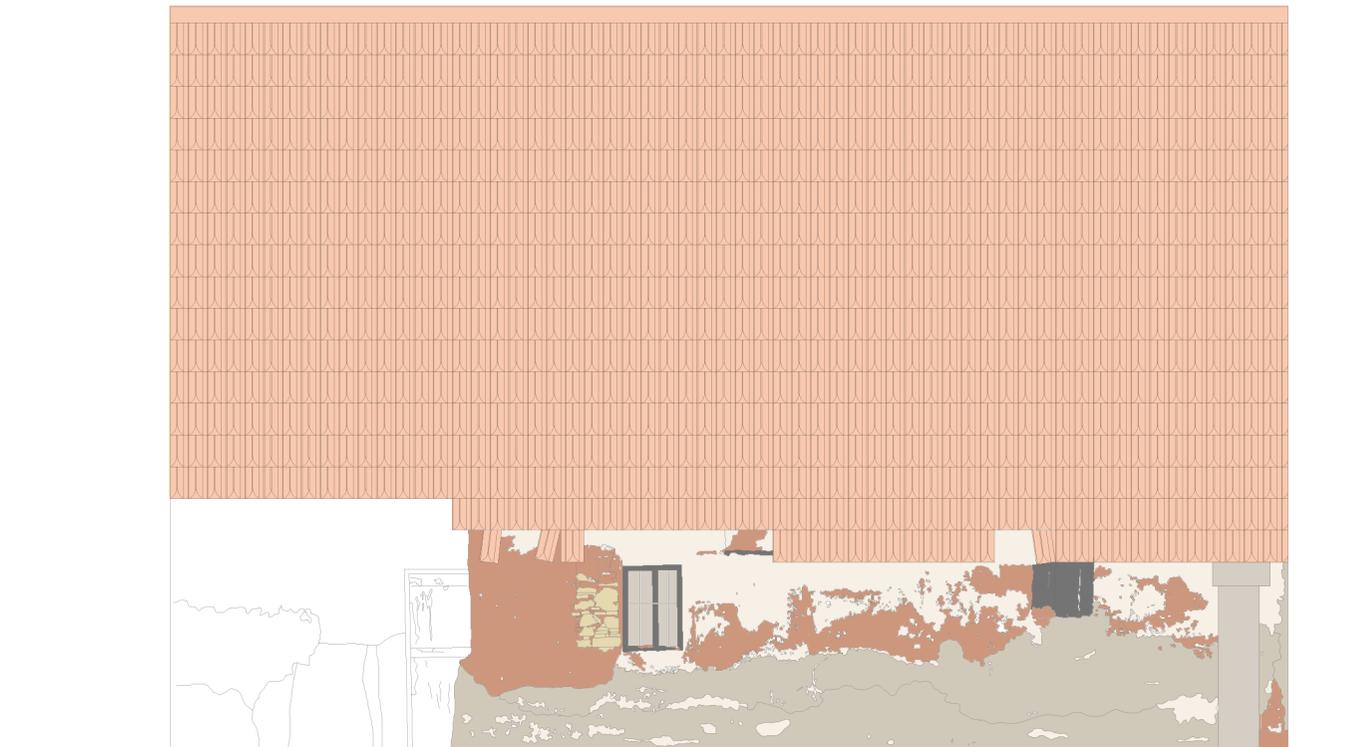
Plano fachada norte. Escala: 1/75. Fuente: Carlos Fuster Aparisi
